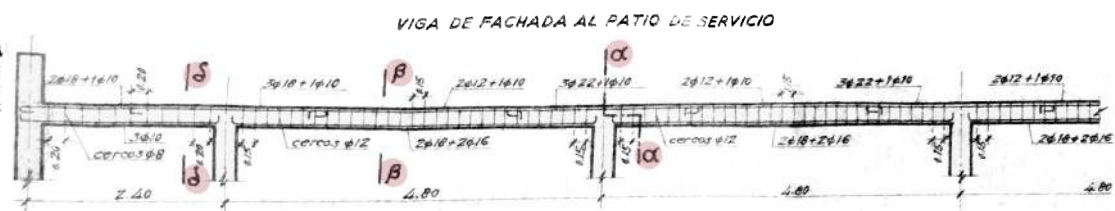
VIGA DE FACHADA AL PATIO DE SERVICIO
